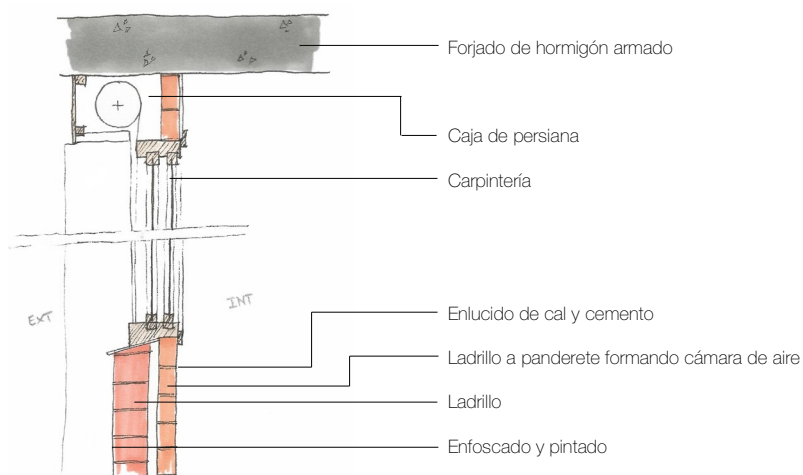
Detalle carpintería en sección (autoría propia).
